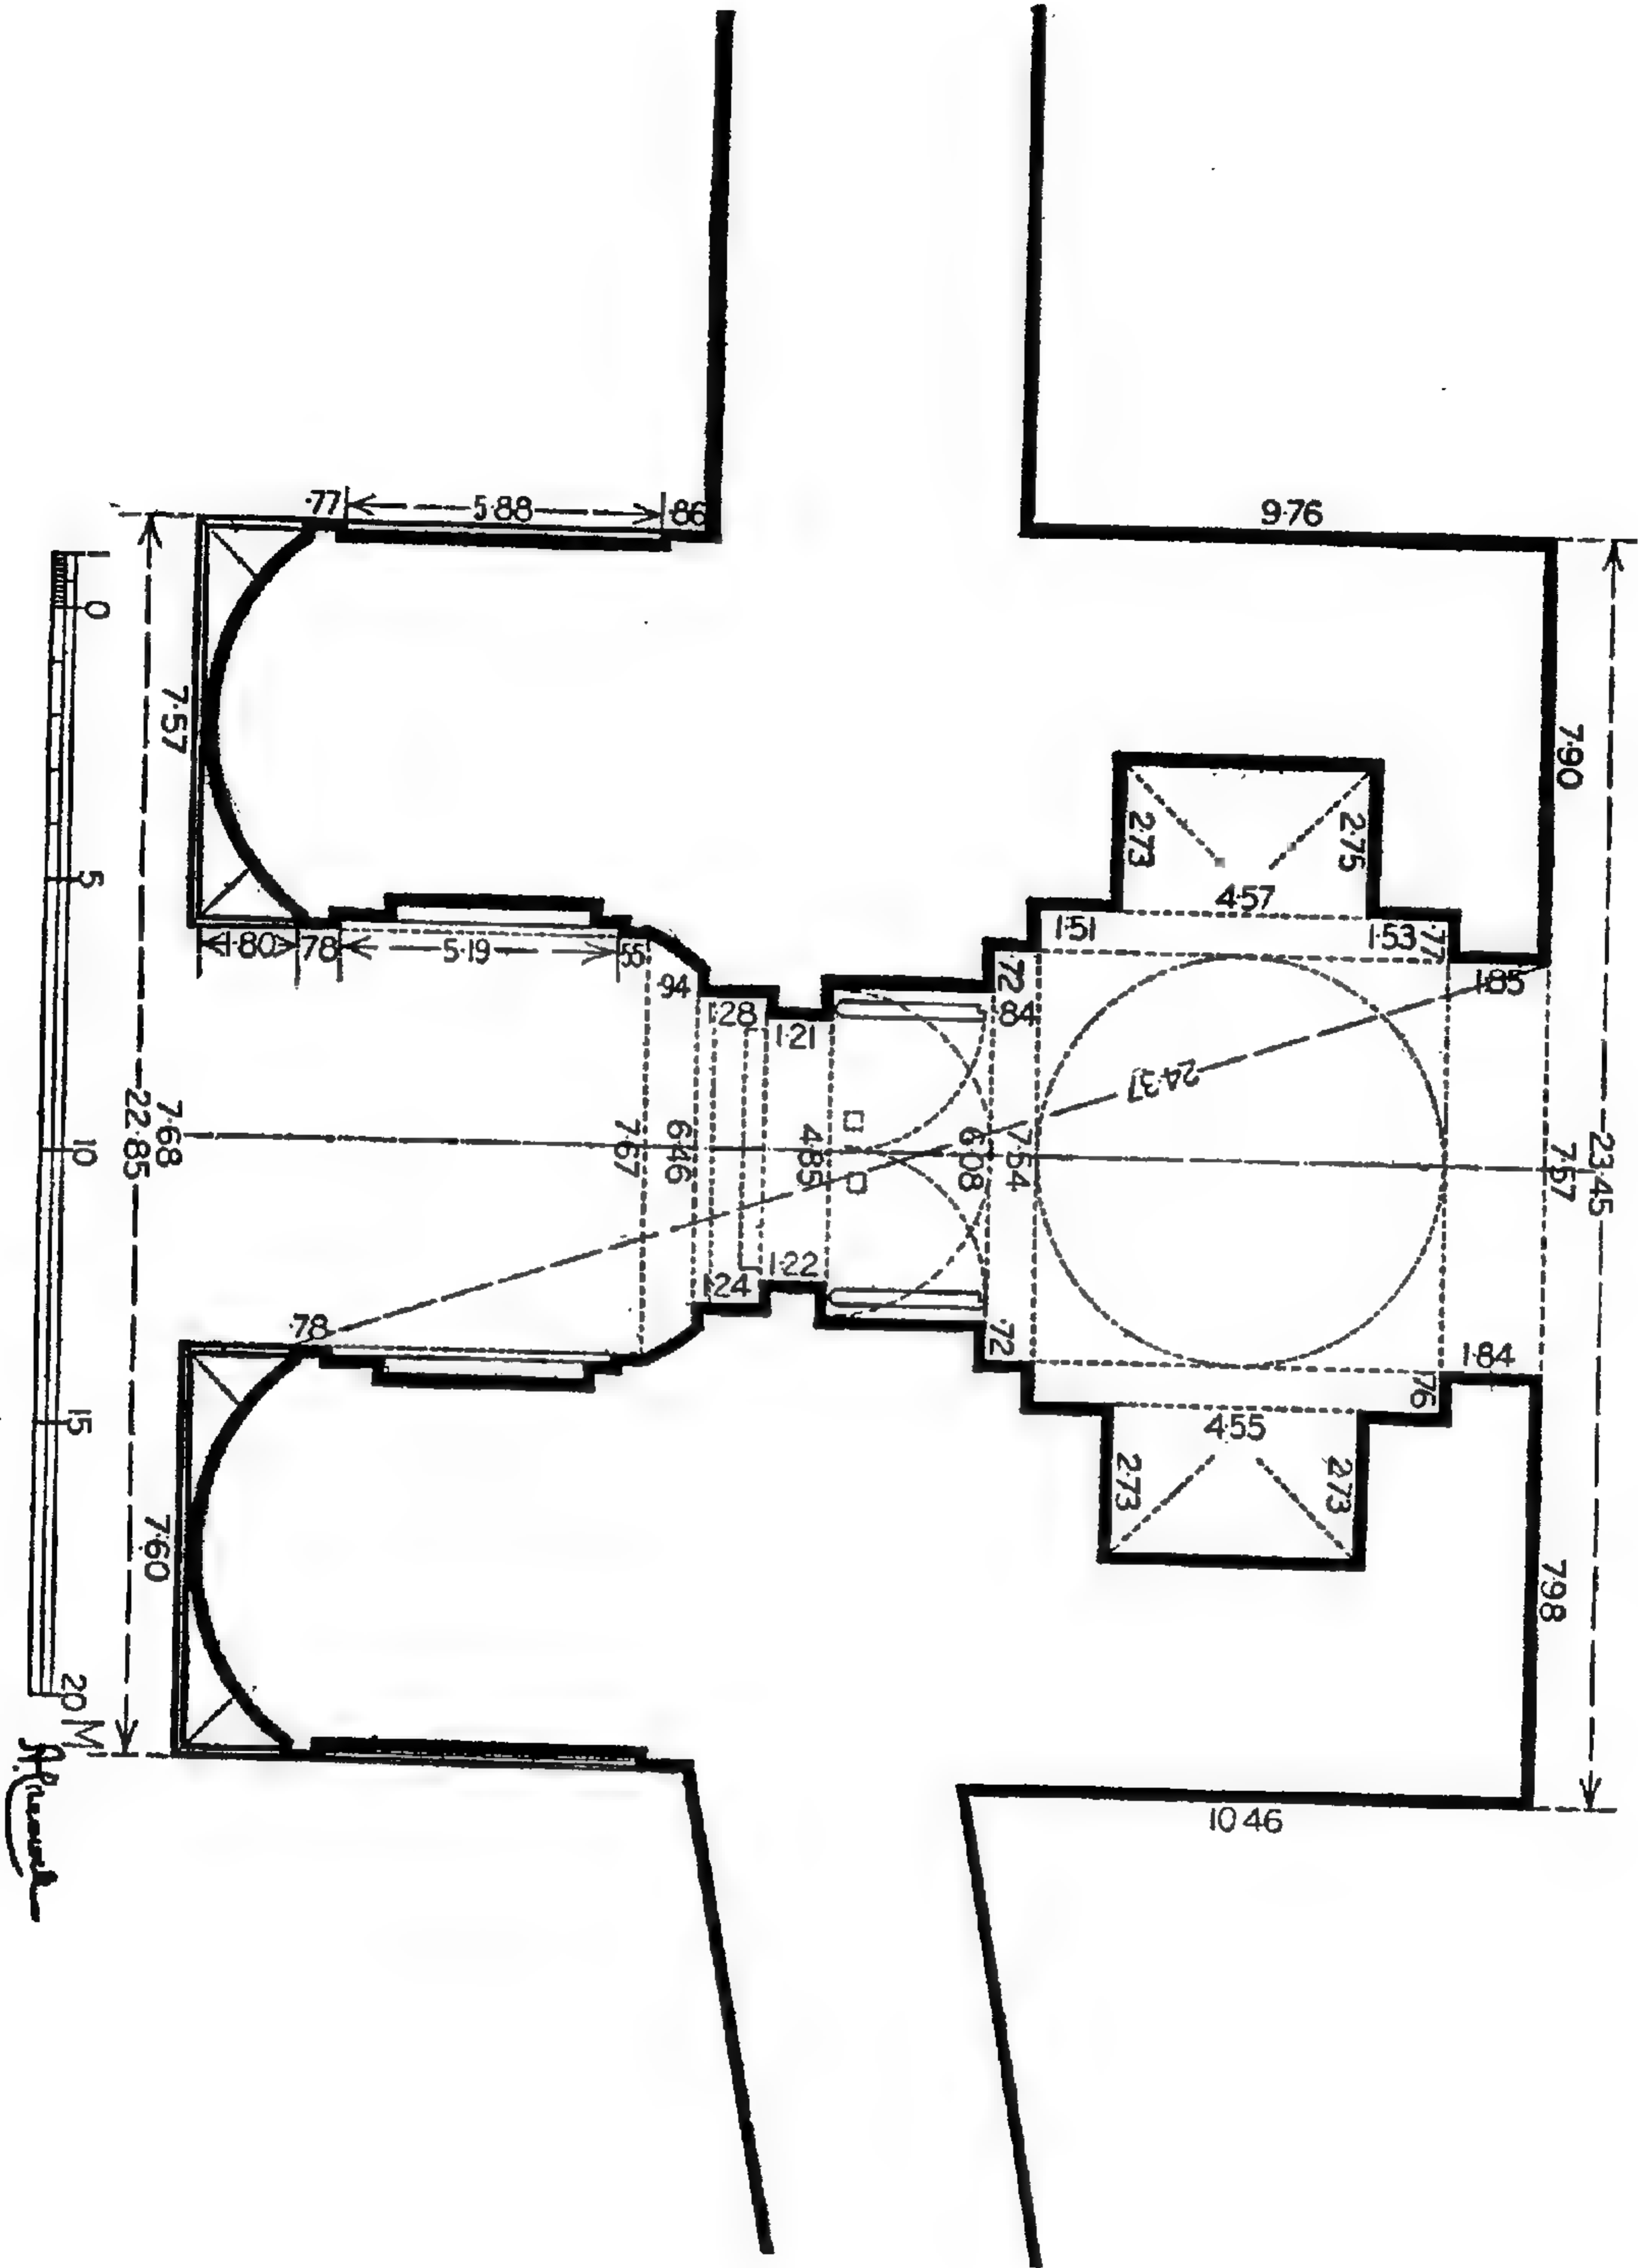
مسجد (مشهد) الجيوشي : مسقط وقطاع .
